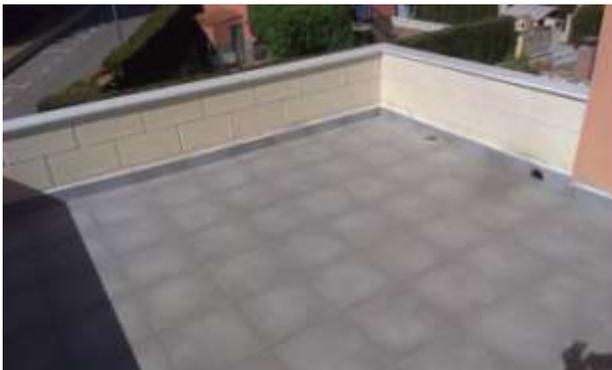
Realización de cubierta en terraza P.2ª, con rebosadero y albardillas en antepechos
